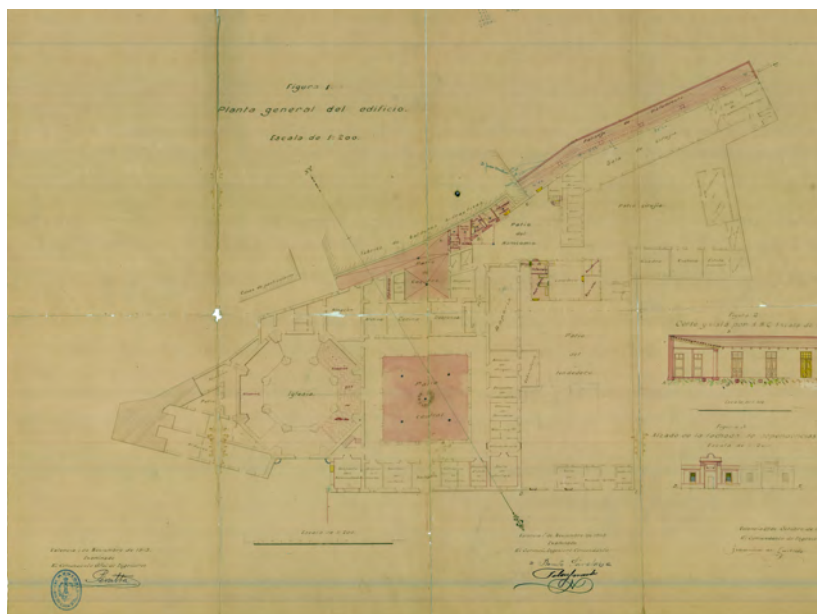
1913. Planta general del Edificio. (Cuartel de San Pío V).
